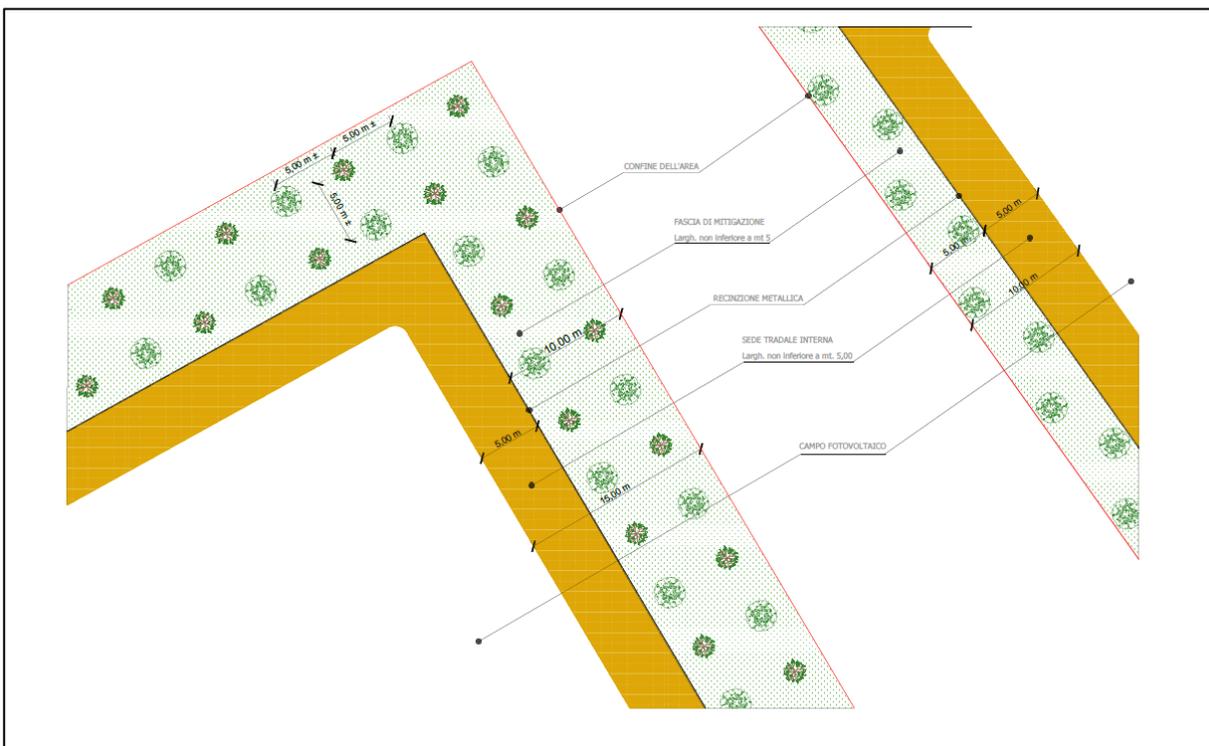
Layout fascia di mitigazione perimetrale- Pianta
